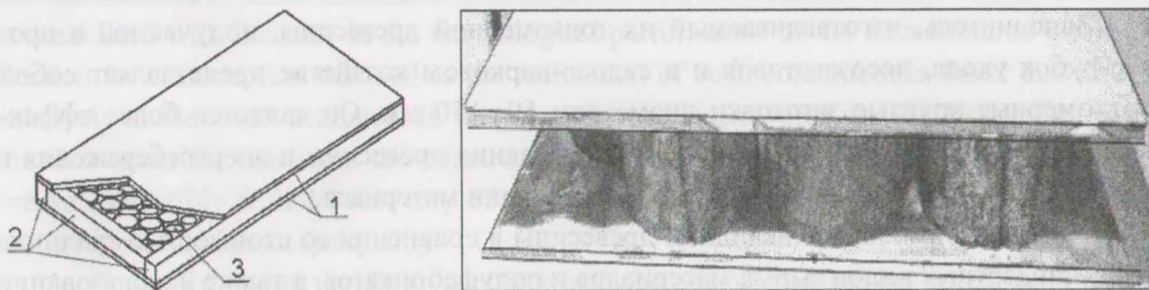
Трехслойный строительный щит: 1 – обшивки; 2 – бруски обвязки; 3 – торцовый заполнитель из круглой тонкомерной древесины
